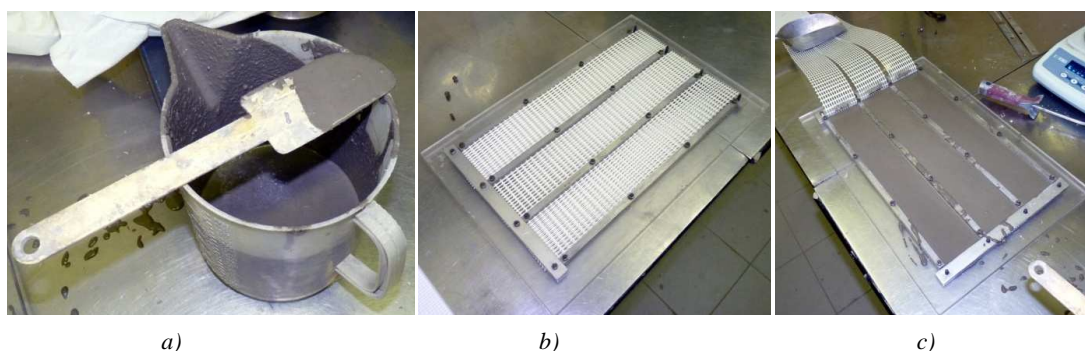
a) Bricchetto pieno di malta; b) cassero in plexiglass con reti ancorate; c) fasi di getto del TRC
